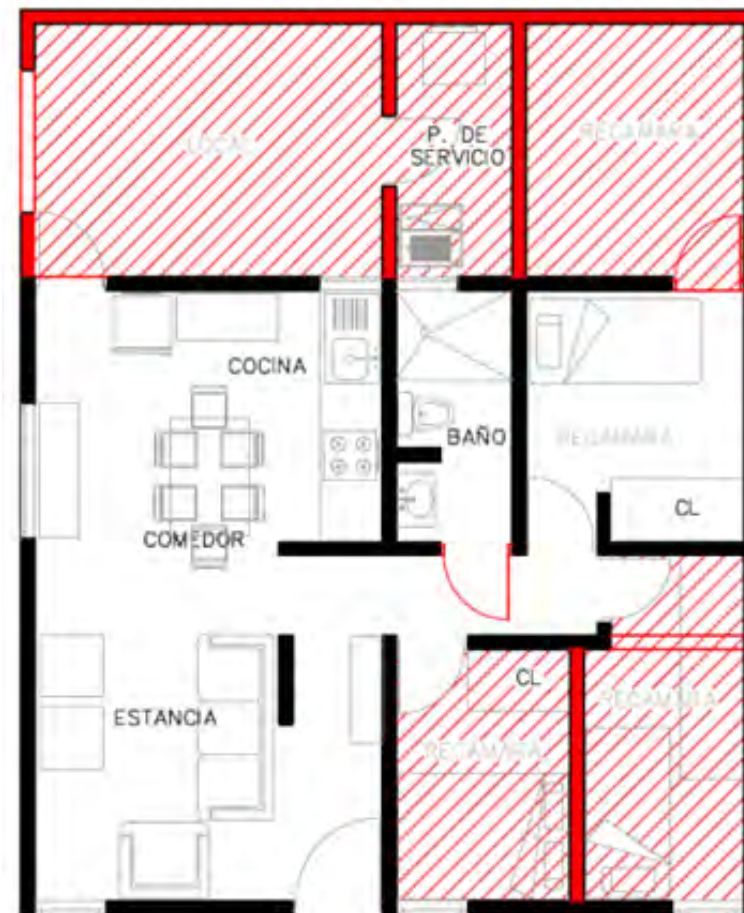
Planta de la vivienda donde con color rojo se indicaron las áreas que presentan algún tipo de modificación constructiva.
